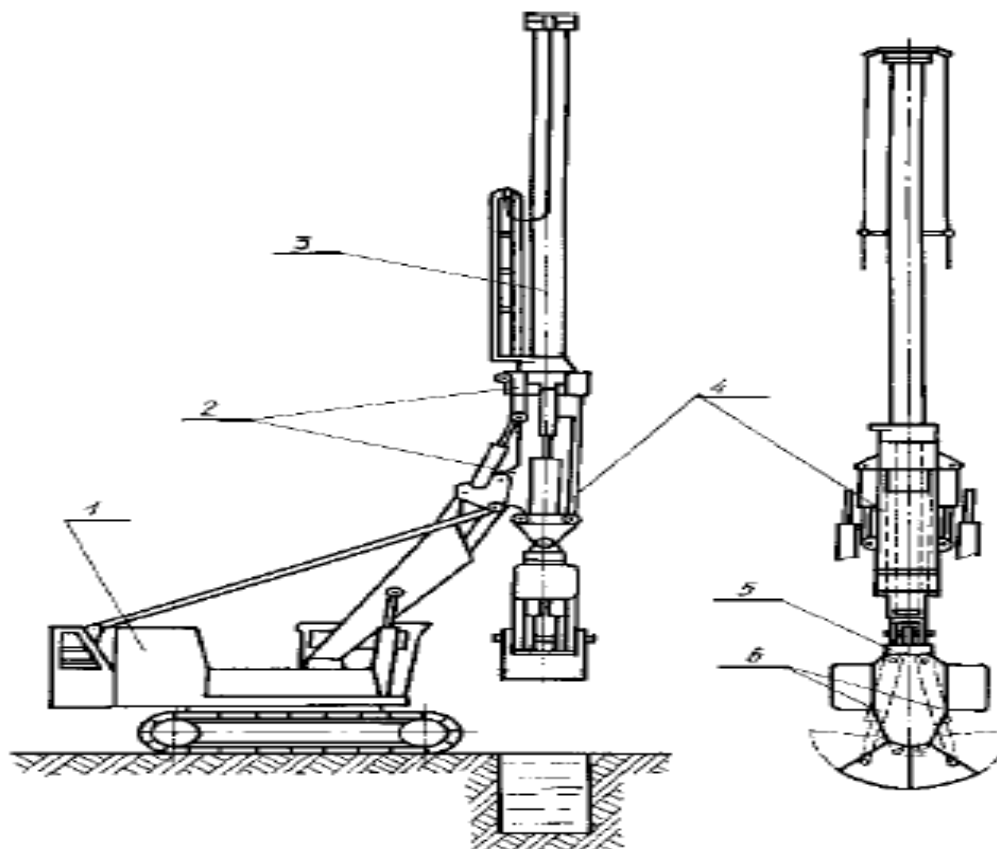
Экскаватор ЭО-5122 с грейферным оборудованием на телескопической напорной штанге: 1 - базовая машина; 2 - блок крепления штанги; 3 - штанга телескопическая; 4 - механизм перемещения штанги; 5 - грейфер; 6 - гидроцилиндры челюстей грейфера
